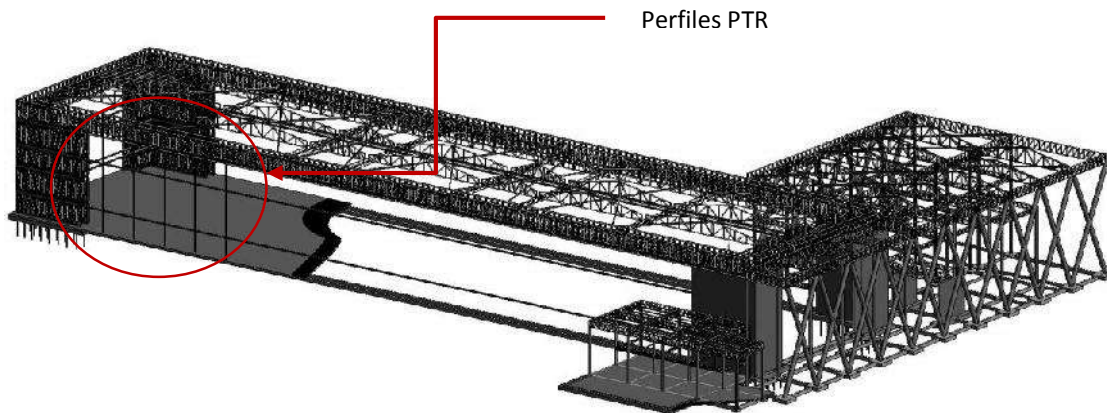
Estructura metálica a base de PTR para el soporte del revestimiento del edificio. Elaboración propia.
